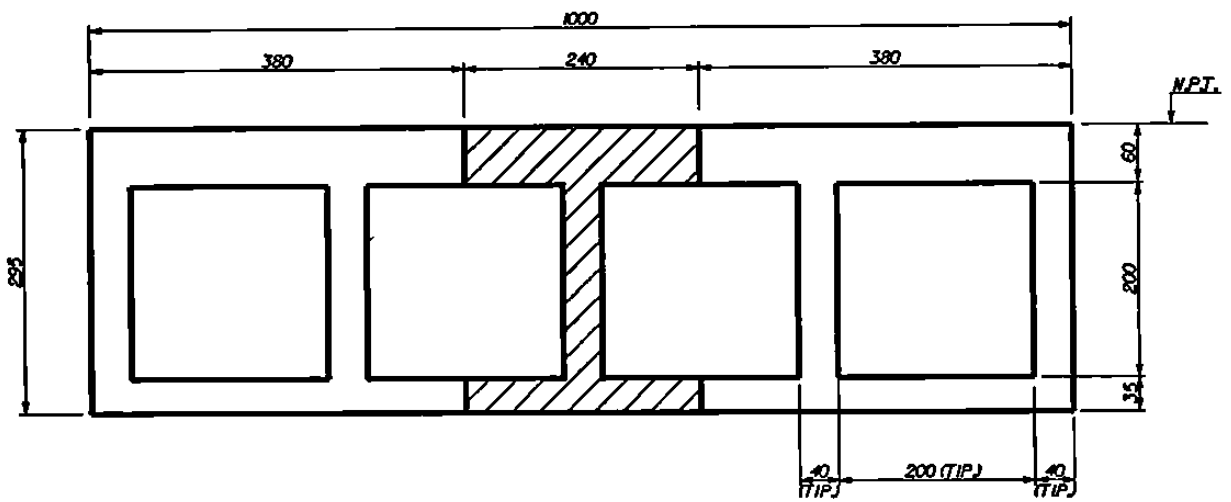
SECCION TRANSVERSAL DE LA LOSA
